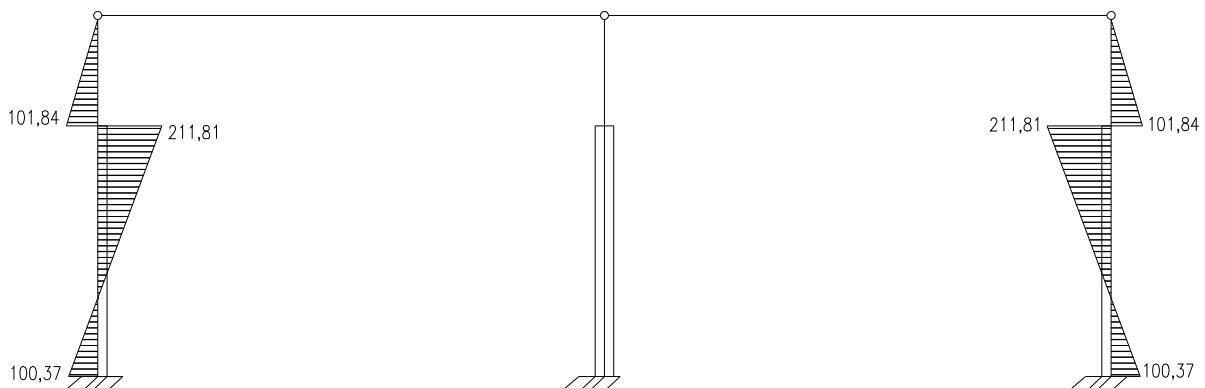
Эпюра изгибающих моментов (кН·м) в колоннах поперечной рамы каркаса СКЦ, возникающих от вертикальной нагрузки, без учета жесткости ригеля
